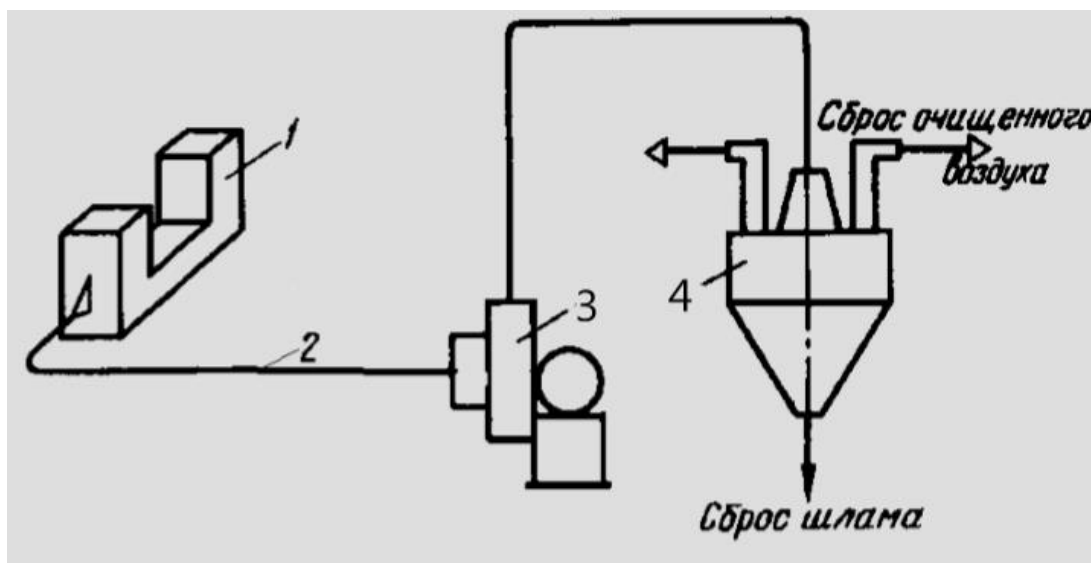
Схема очистки воздуха от пыли: 1- вход запылённого воздуха; 2-воздуховод; 3- вентилятор; 4- мокрый пылеулавливатель
